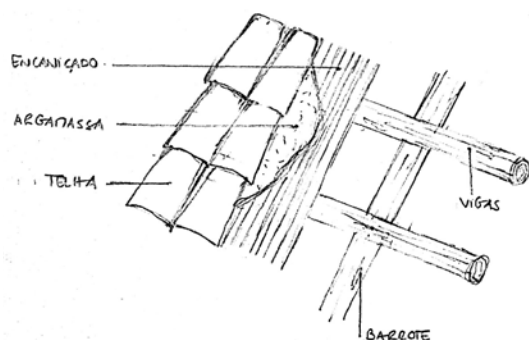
Esquema de sistema construtivo tradicional: telhado de telha argamassada com “encançado”. (Ilustração Nossa, 2017)
